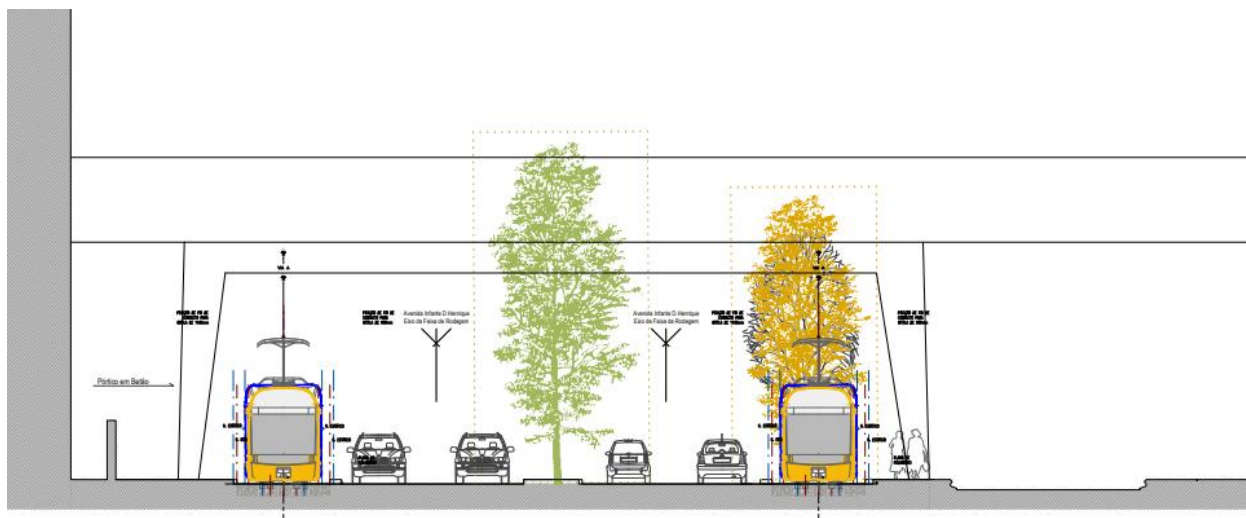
Pórtico da Nacional - Perfil transversal – traçado de Referência
